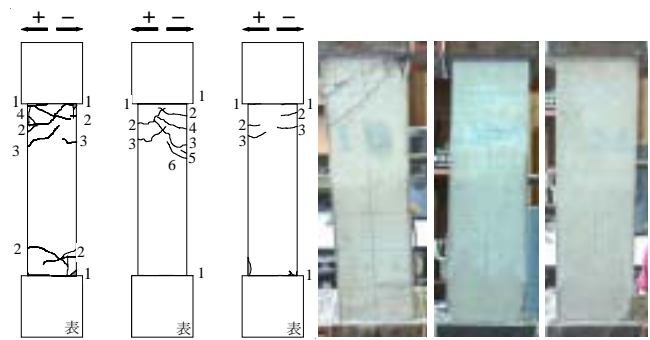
1/50rad.時のひび割れ 写真-1 最終状況の写真
